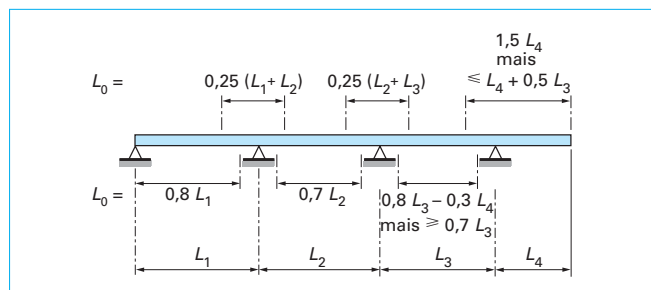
Largeur participante de dalle pour une poutre de plancher
